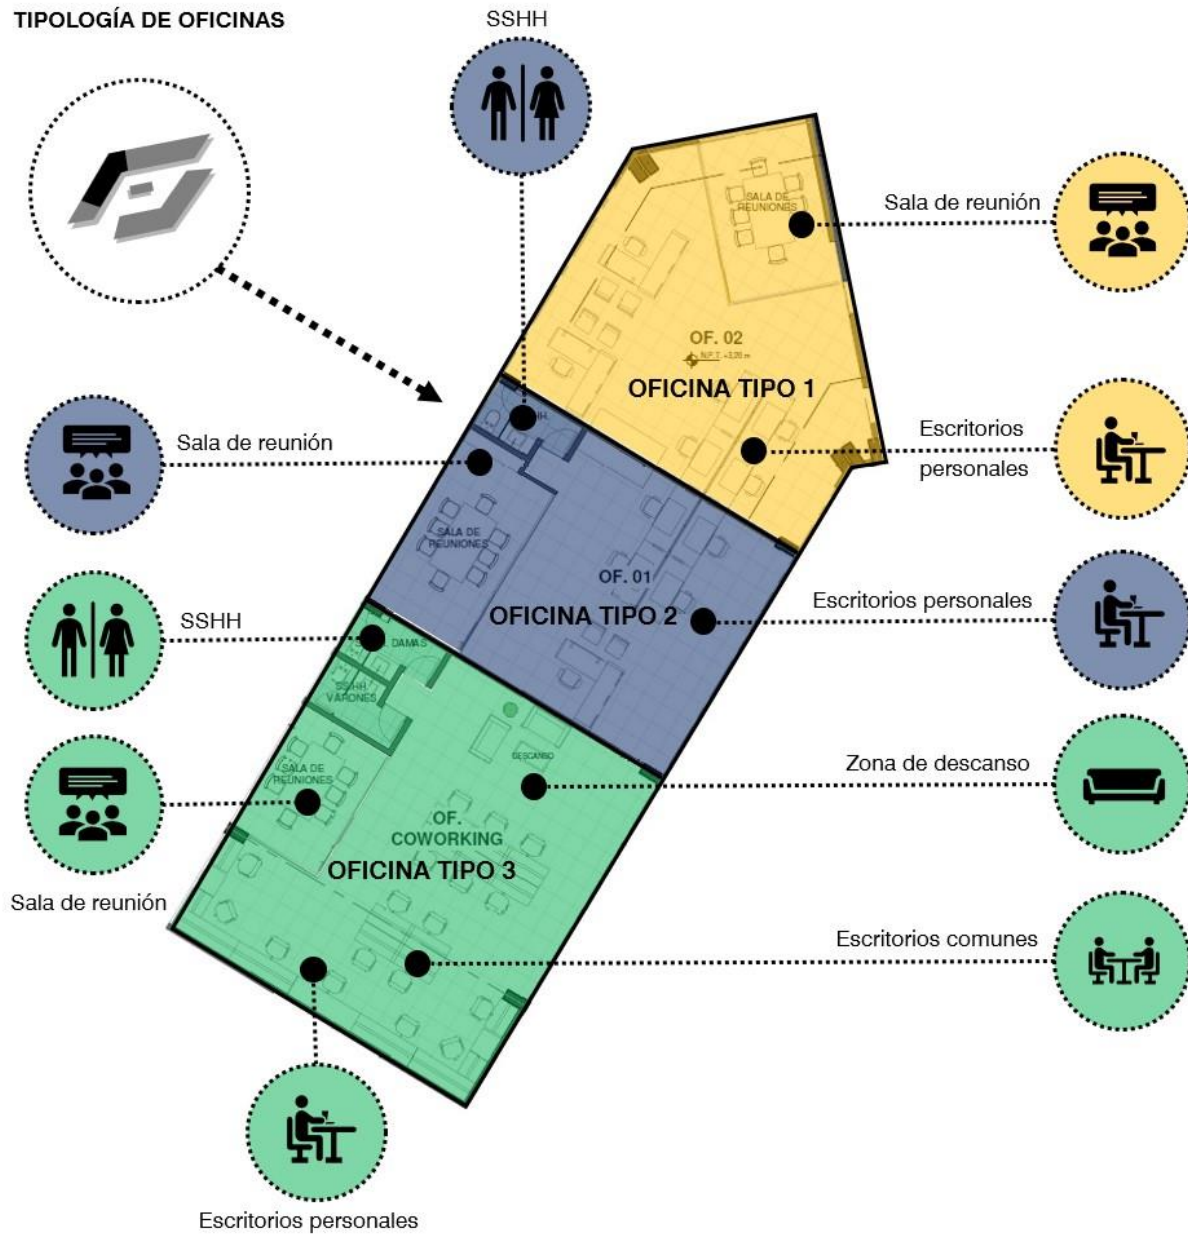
Tipología de oficinas del proyecto. Elaboración propia
